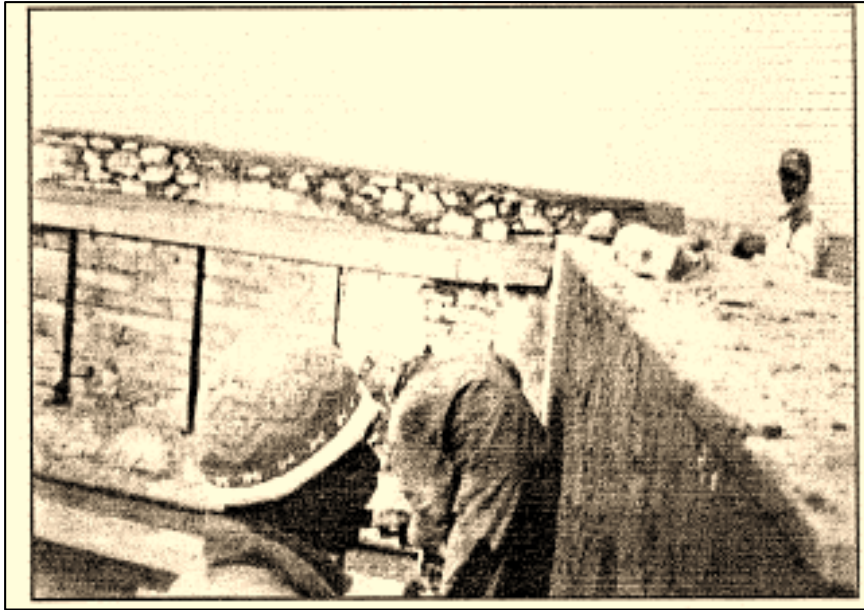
6 travail sur l'enduit de mur extérieur / photo prise par le bureau d'étude ARTEC
